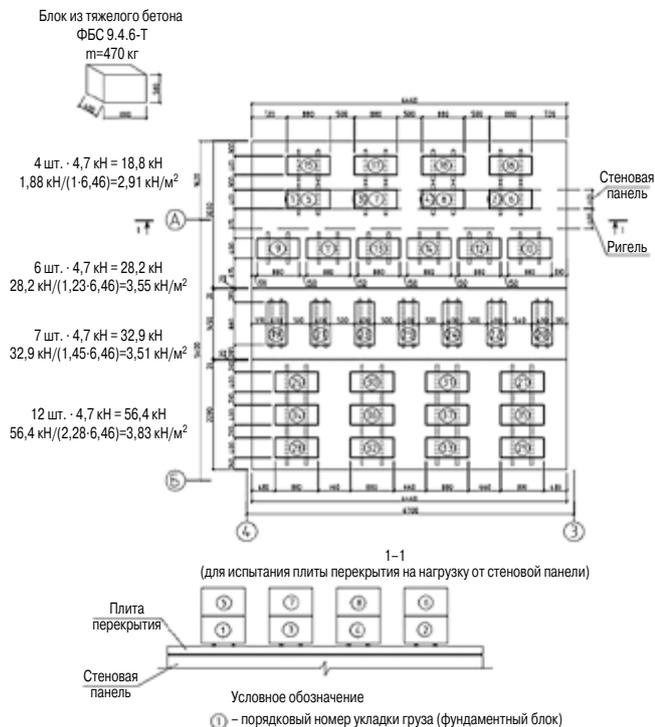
Схемы испытаний и загрузки плит перекрытия
